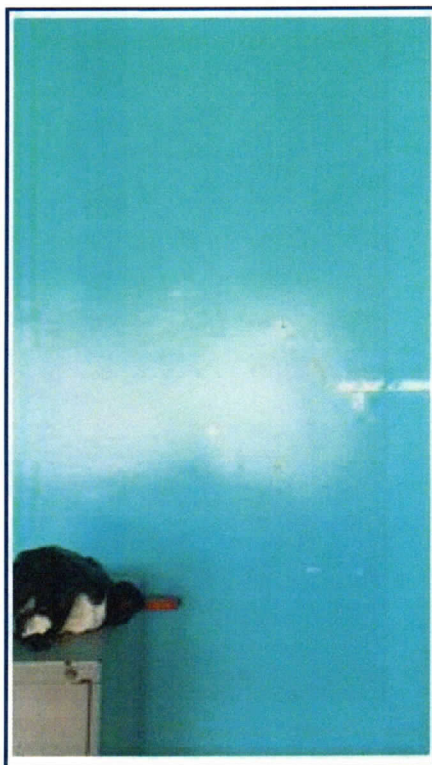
Paredes de alvenaria com fissuras decorrentes da dilatação térmica da laje.
